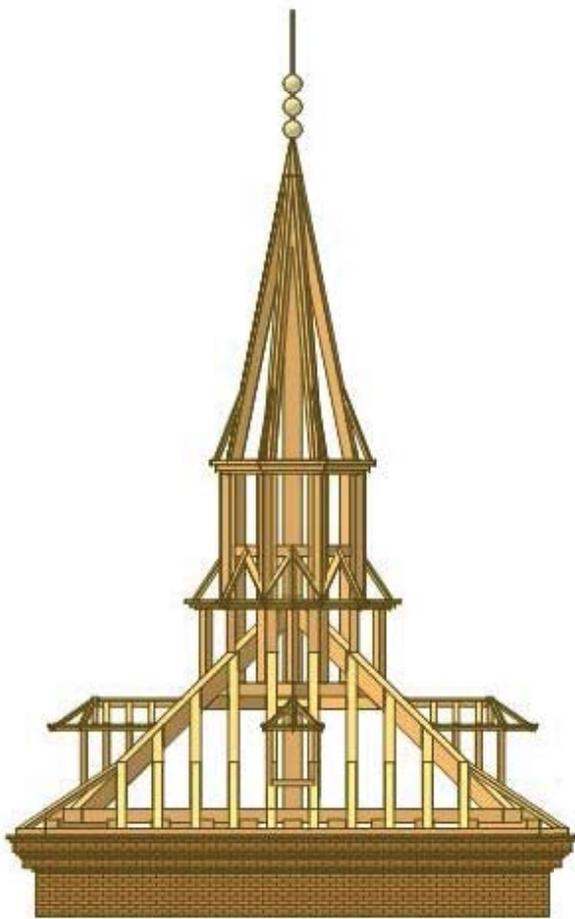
Planta y alzado de la armadura del chapitel con los adosamientos del segundo cuerpo D.A.
